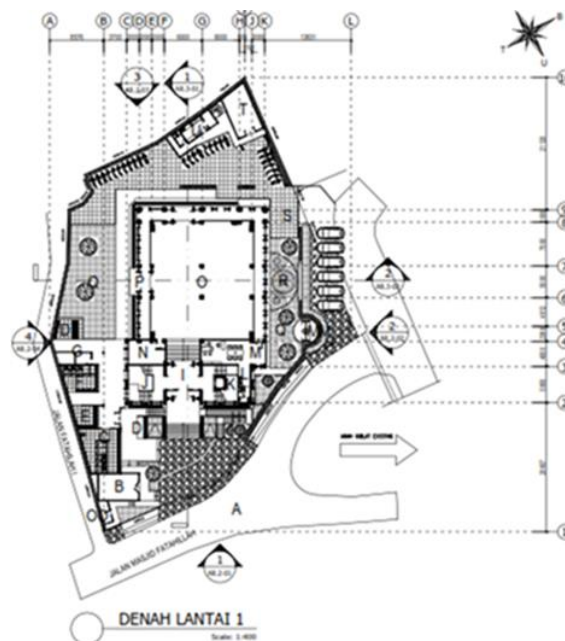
Bangunan Masjid menjadi tingkat 3 (lantai dasar, lantai satu, dan lantai dua). Penambahan jumlah lantai (lantai satu dan lantai dua) sebagai ruang sholat pria dan Wanita
